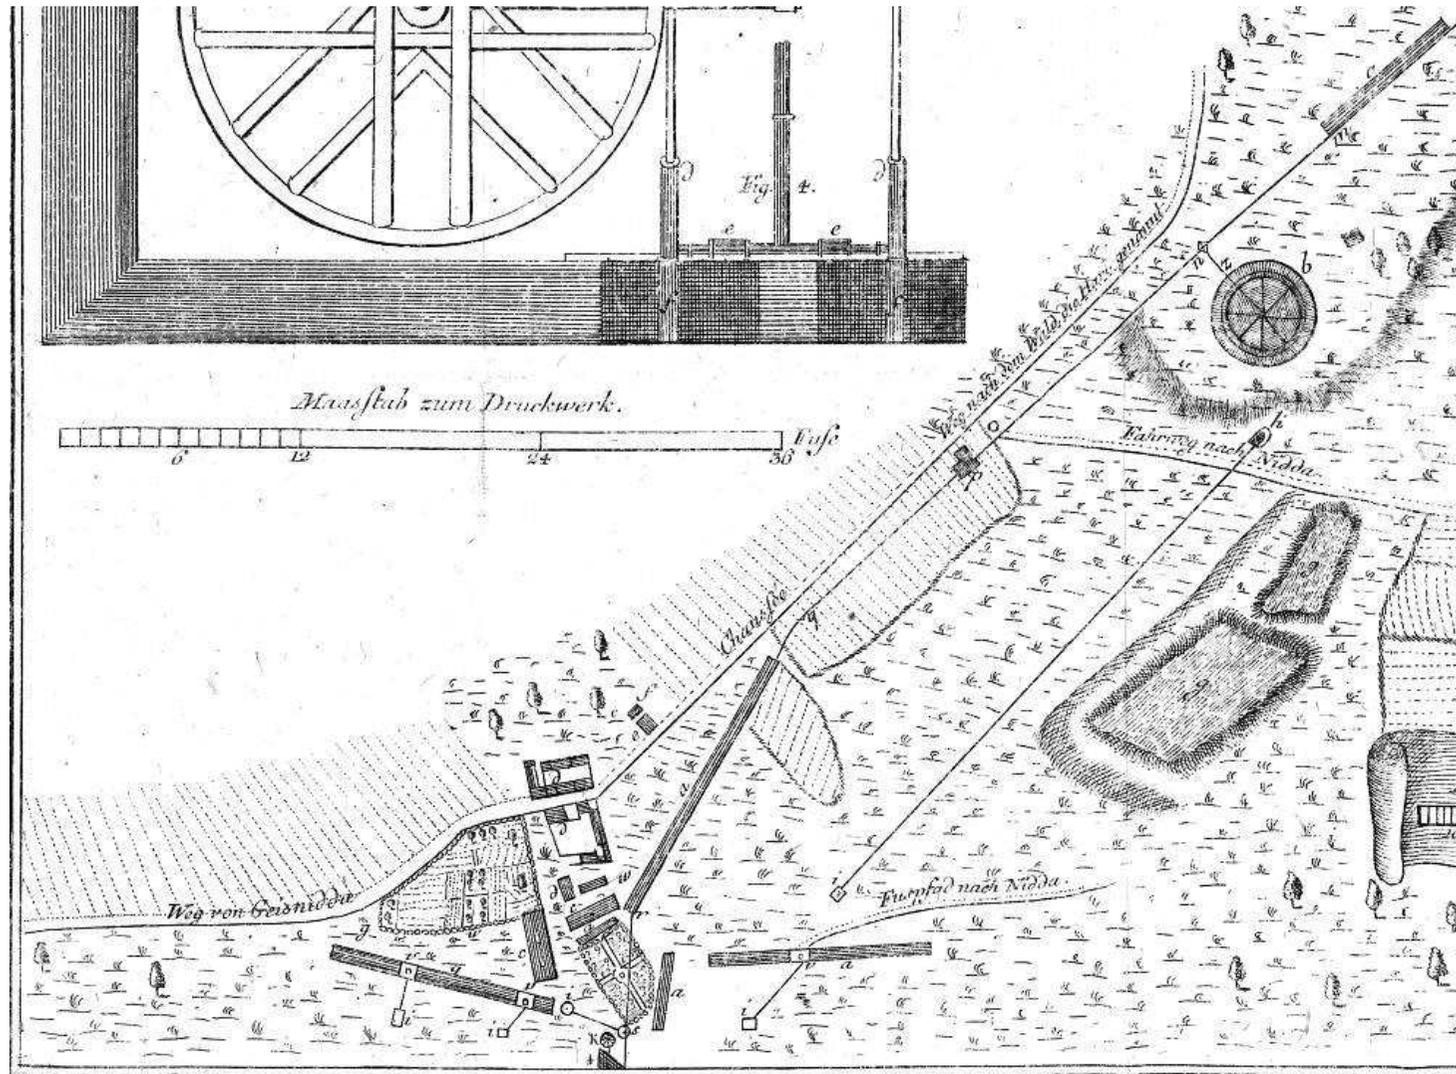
Ausschnitt des Planes vom Salzwerk mit Rund-Gradierbau (rechts oben)
